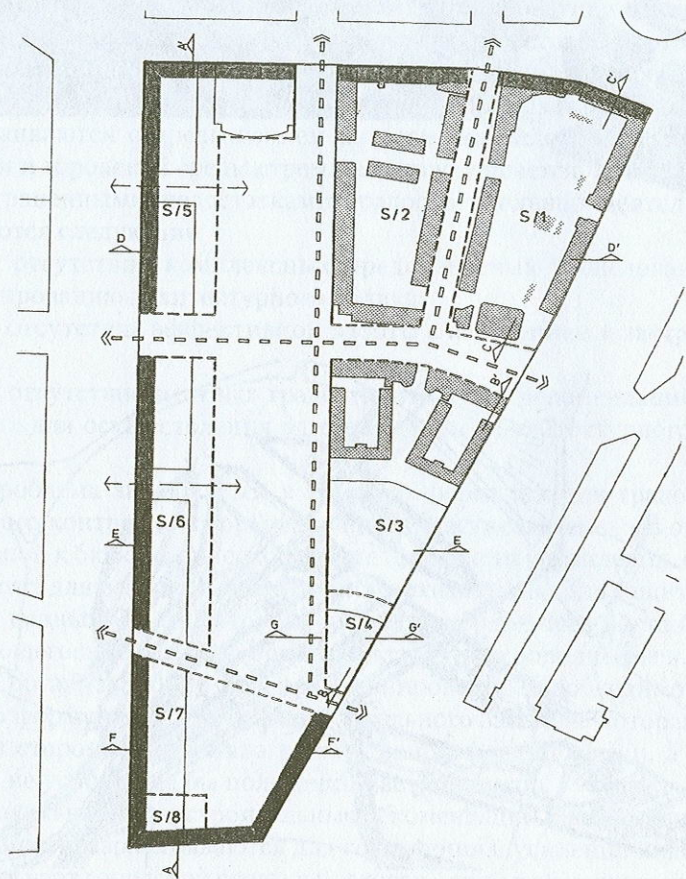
б. Схема организации застройки и габаритные схемы кварталов. Брошюра — «Район Коп-ван-Зюйд», г. Роттердам, Нидерланды: планировочная схема квартала 1.
